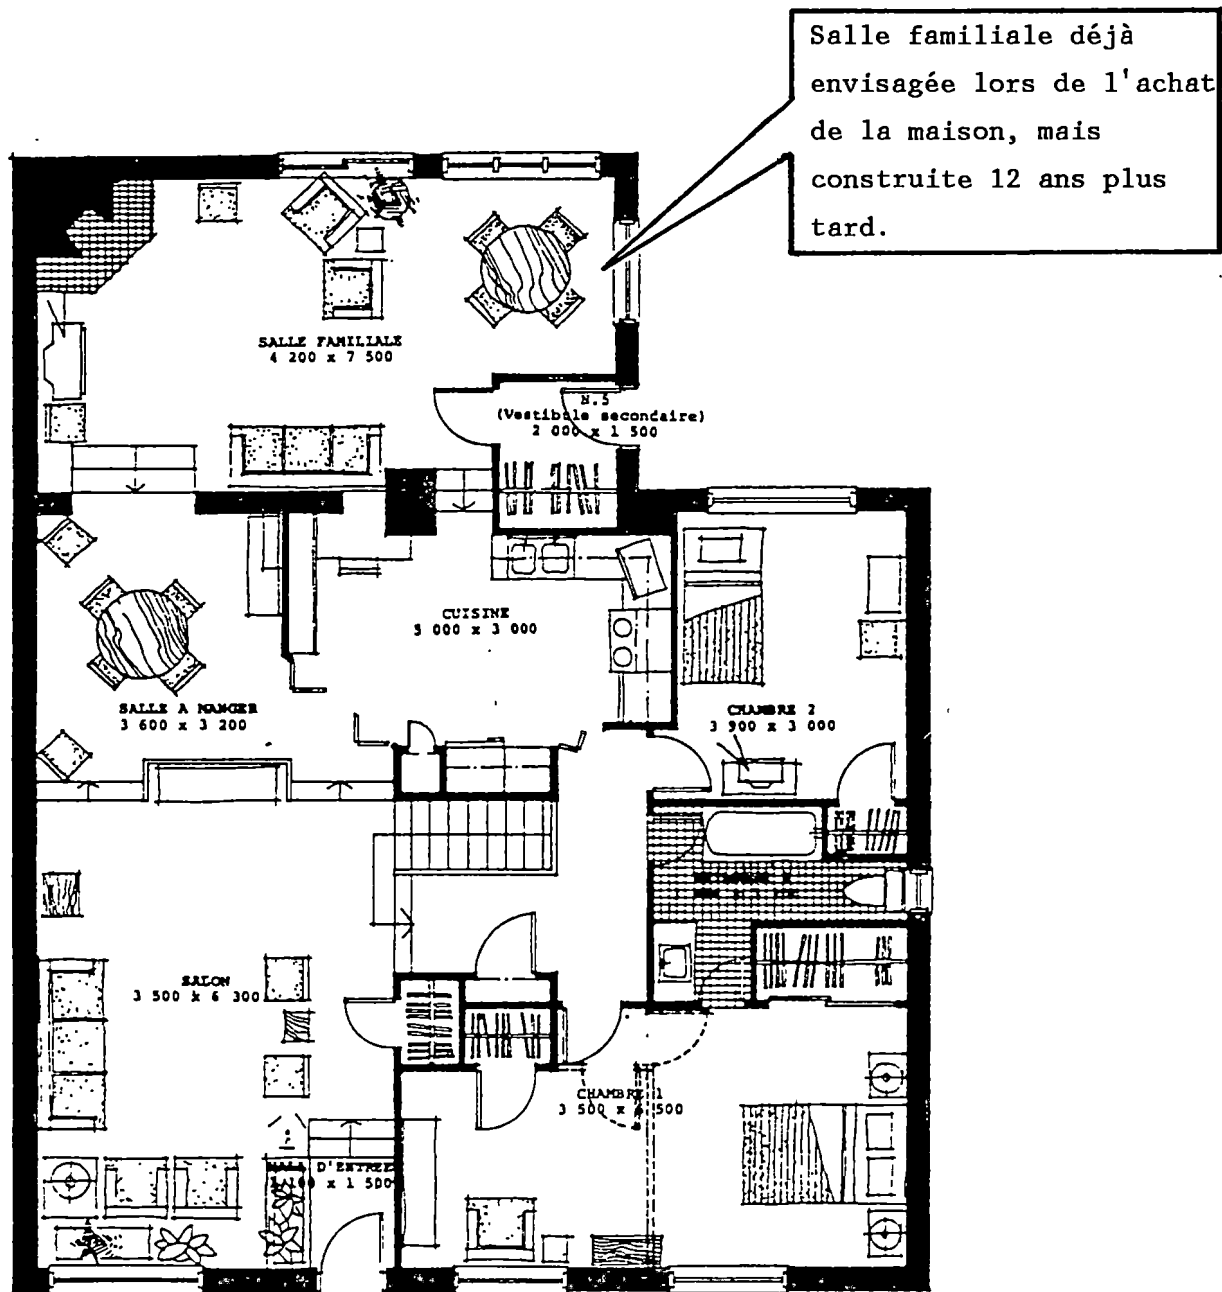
Plan du rez-de-chaussée d'une maison à mi-étages, Famille 09 (0971). Échelle 1/100.
